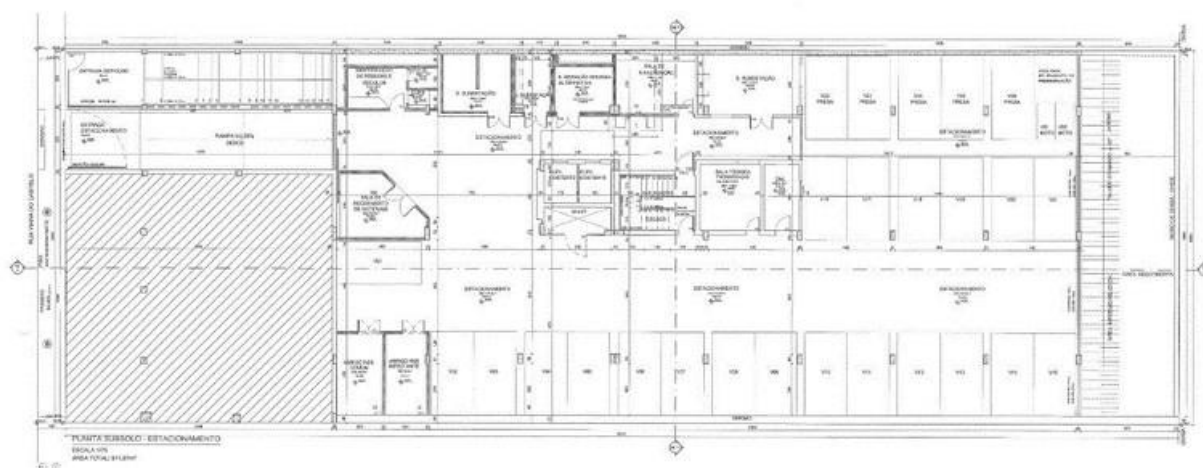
Projeto aprovado na ANVISA – Planta Subsolo.
